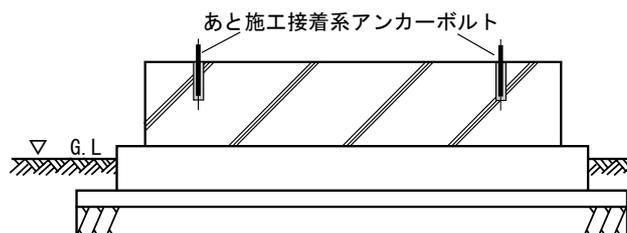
基礎施工例 資料提供) 森松工業（株）
